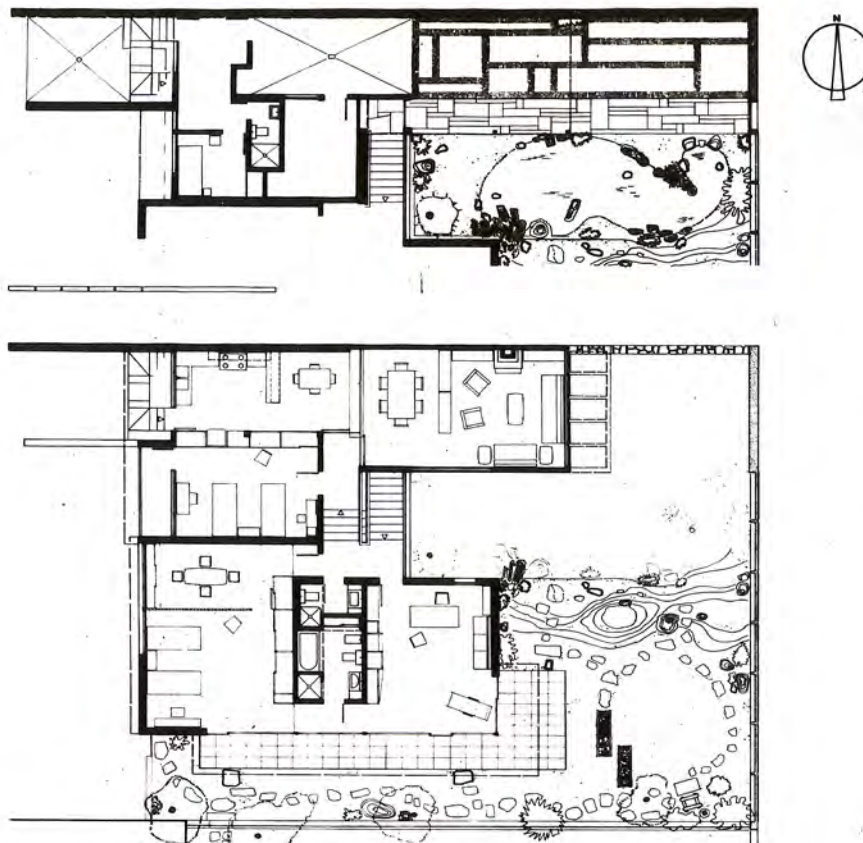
Casa Ashida, Grundriss Erd-, Zwischen- und Obergeschoss
